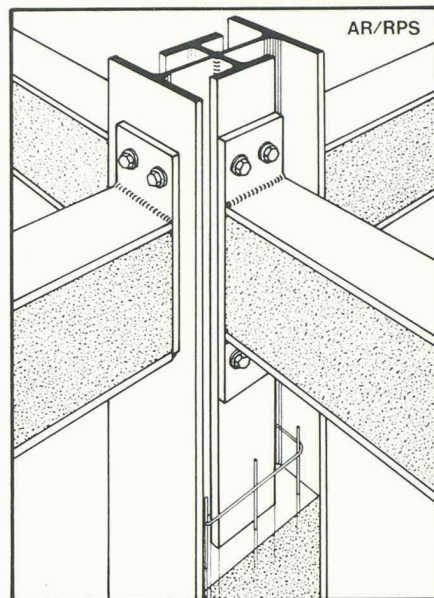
Construction mixte AF avec assemblages poutrelle-colonne.
